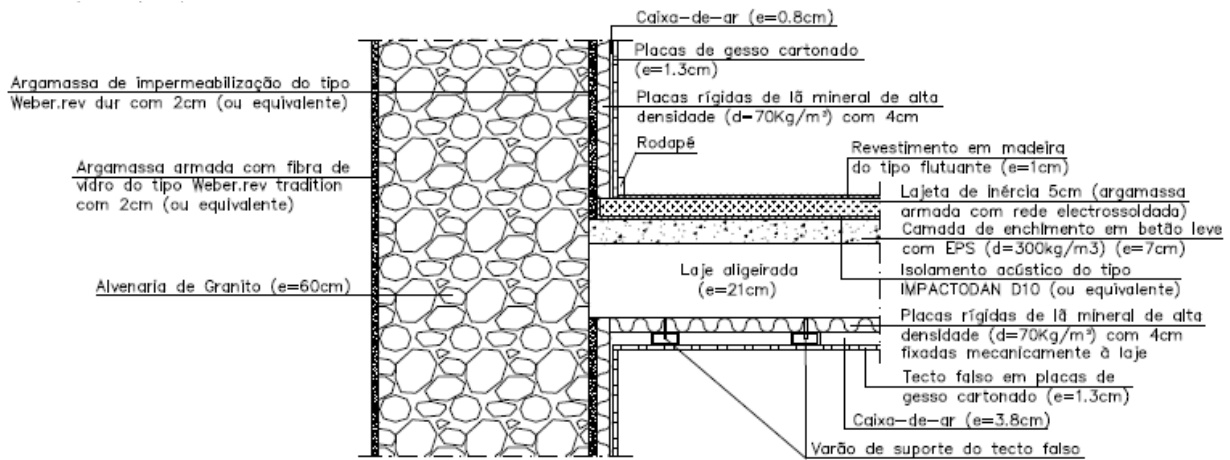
Pormenor de ligação entre a parede exterior e o piso 4 de separação entre frações (Projeto de CT)
